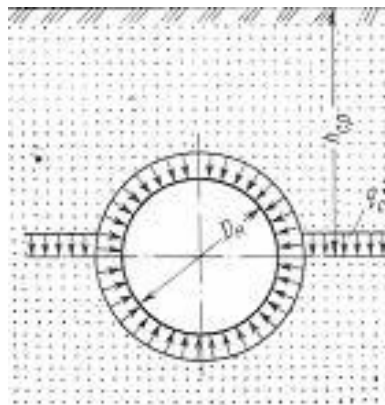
Среднее давление грунта на подземный трубопровод
